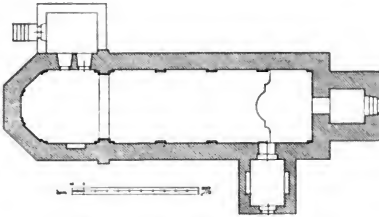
Střebsko. Grundriss der Kirche.
